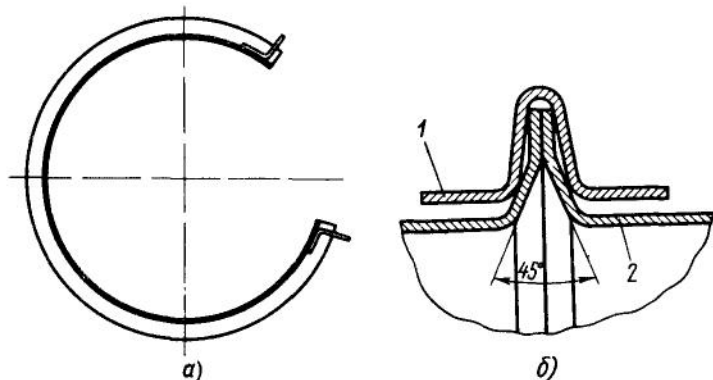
Бесфланцевые соединения воздуховодов круглого сечения: а – бандаж, б – узел соединения; 1 – бандаж, 2 – воздуховод
